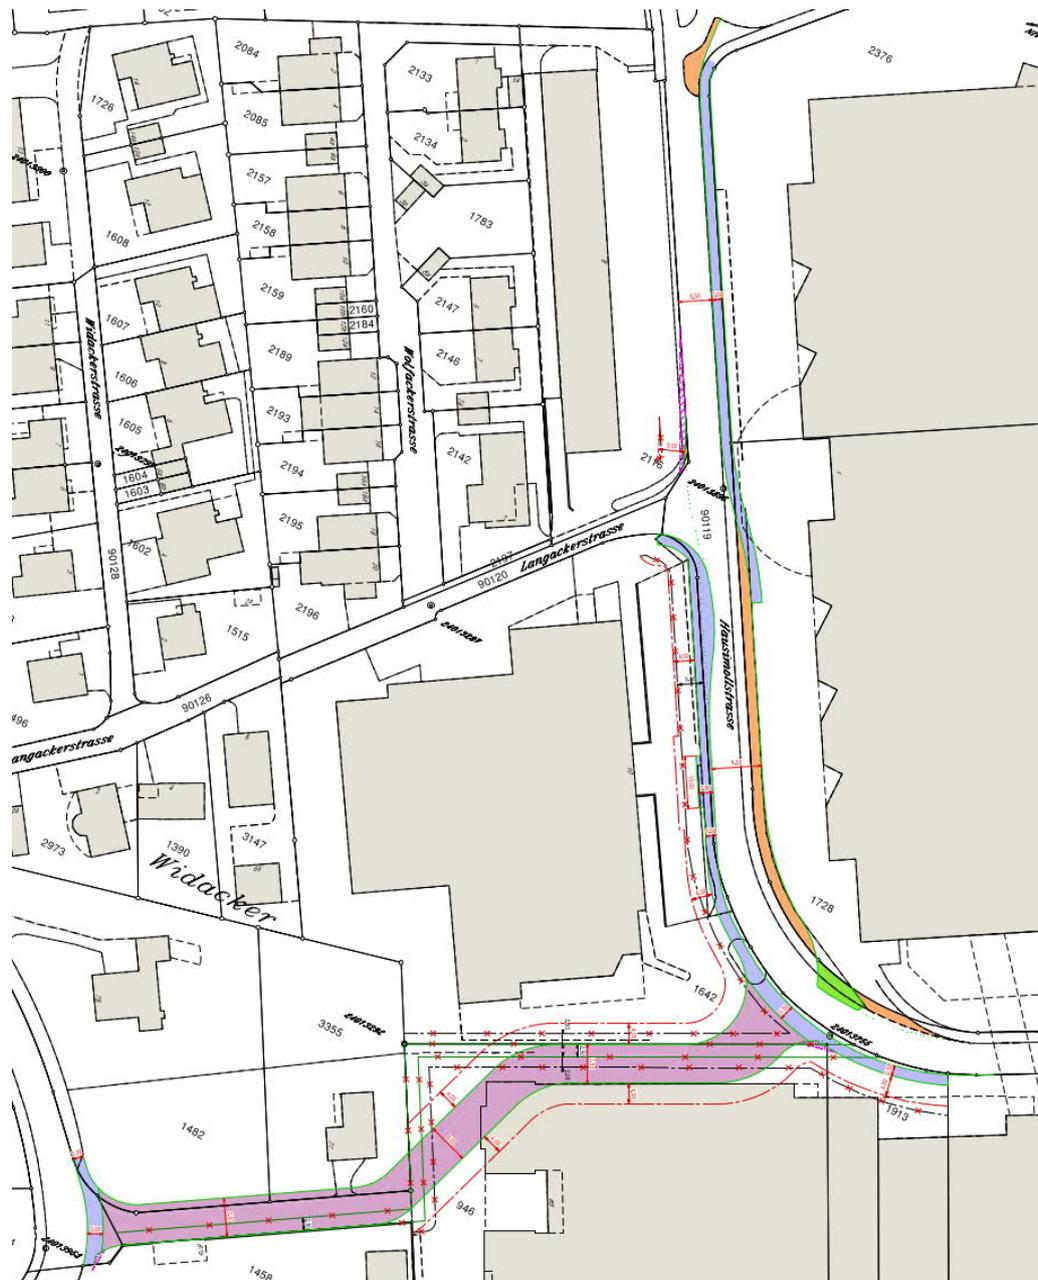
Ausschnitt der Änderungen an der Hausimollstrasse (Plan Nr. 325229/06)
